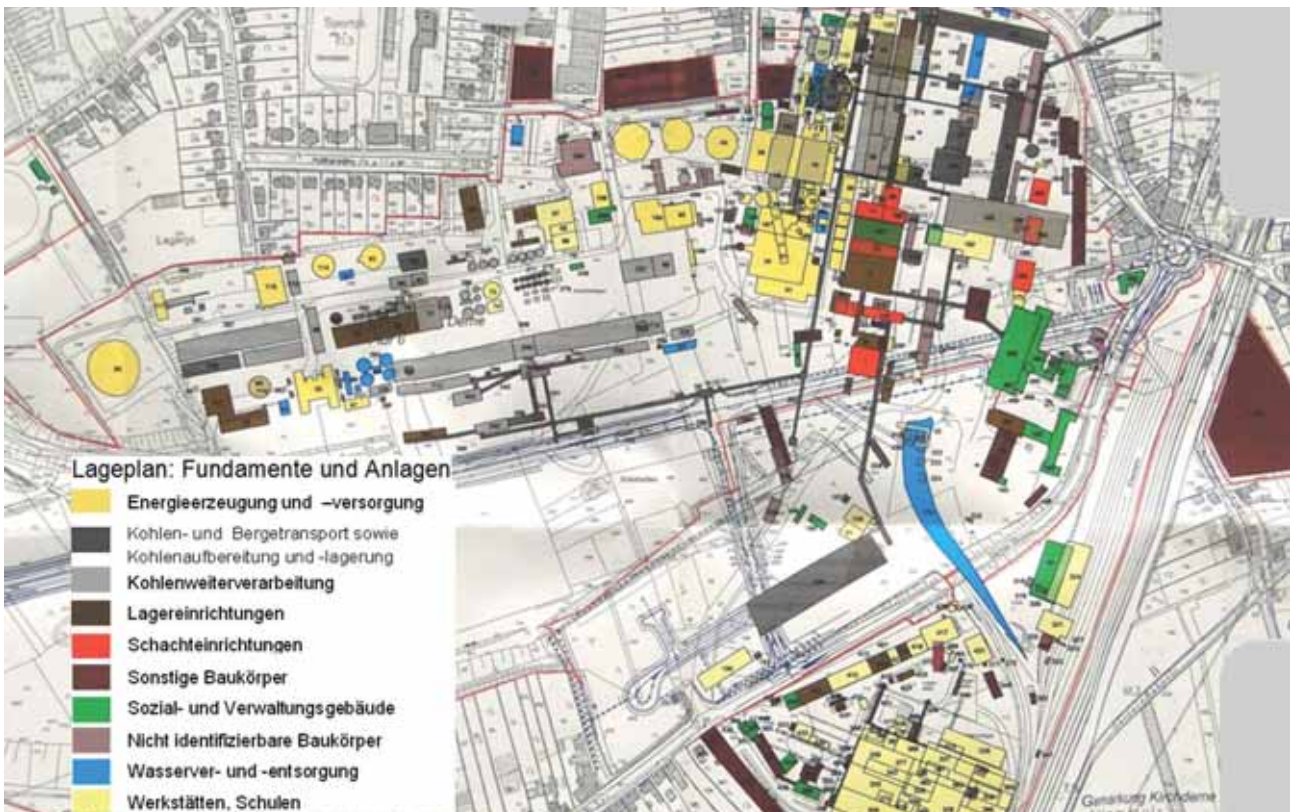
Lageplan Tagesanlagen und deren Fundamente
